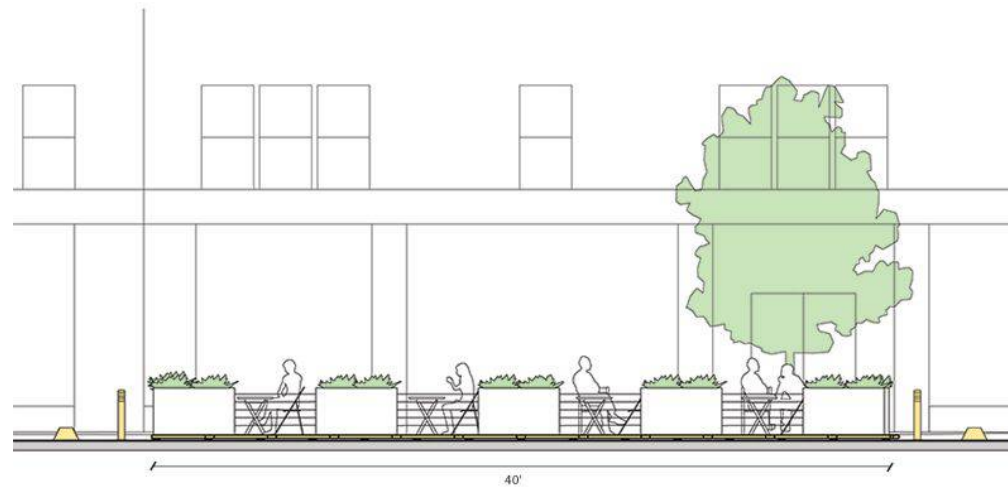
Plan de coupe-Exemple d'aménagement des terrasses
